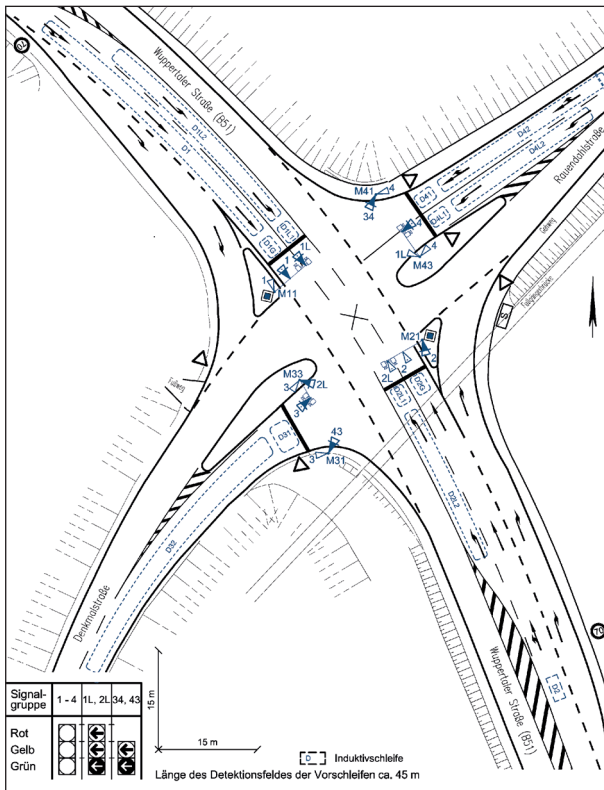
Signallageplan des Knotenpunkts Wuppertaler Straße/Denkmalstraße/Rauendahlstraße in Hattingen
